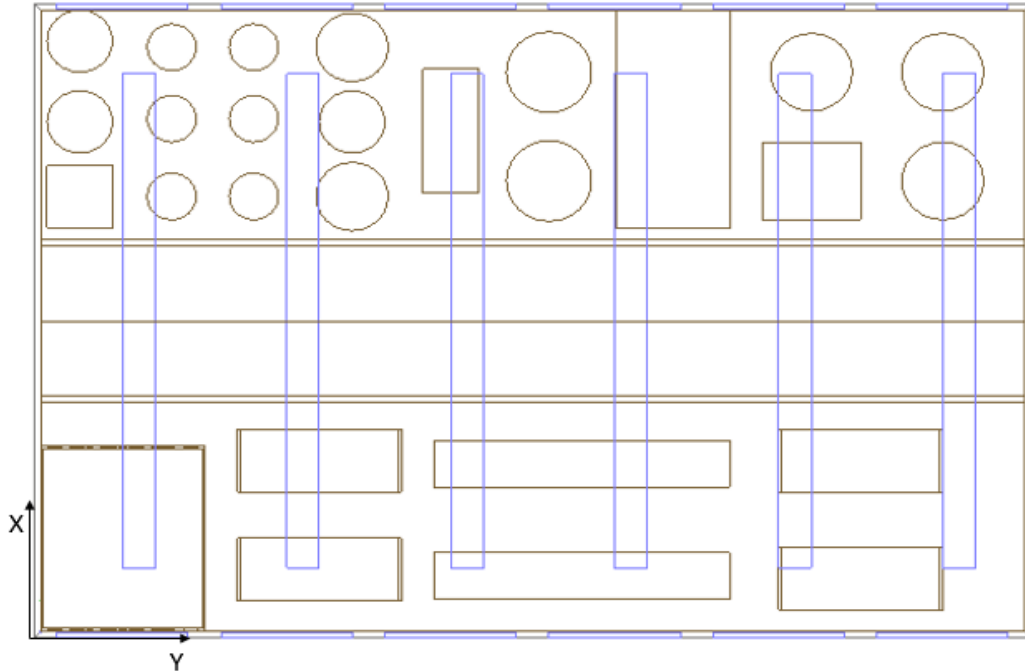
Vista de la planta de la nave industrial, propuesta 2. Fuente DIALux.
